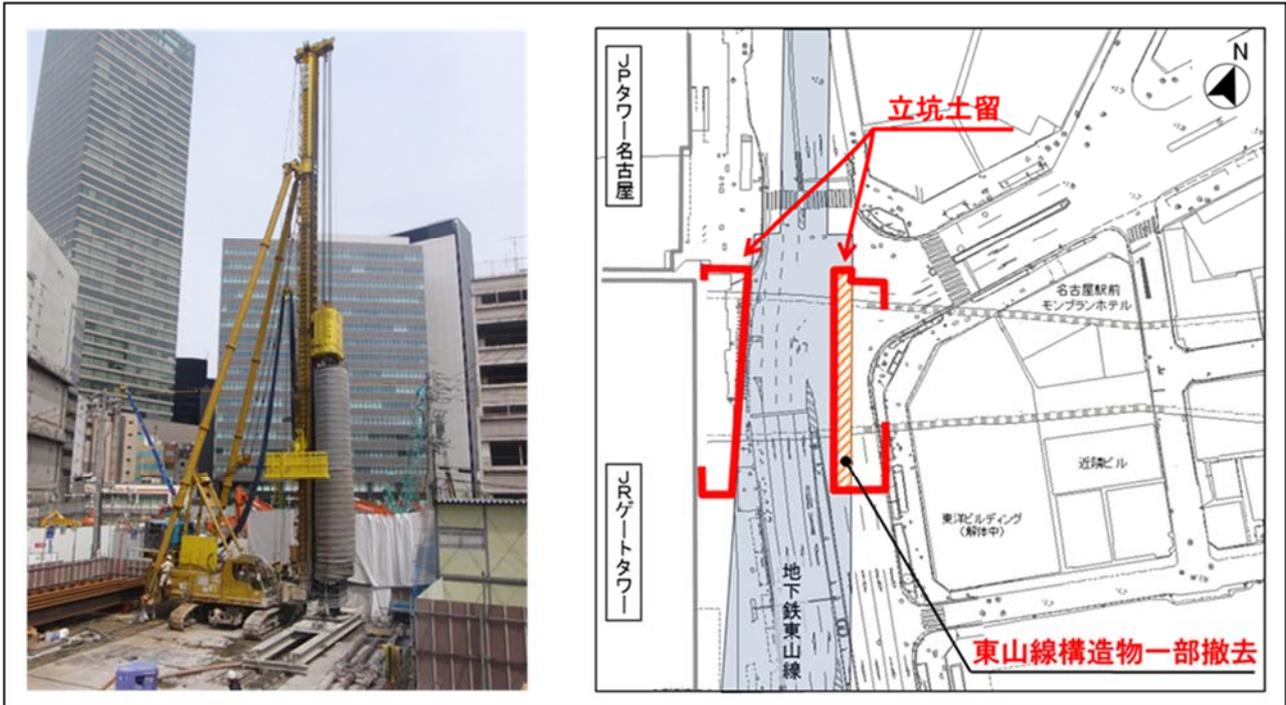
(2) 立坑土留工の施工手順（写真は類似工事の例）
